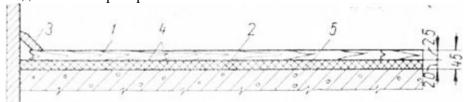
Конструкция пола из паркетных досок по сплошному звукоизоляционному слою 1- паркетная доска; 2- древесноволокнистая плита; 3- галтель; 4- холодная мастика; 5- железобетонное перекрытие
